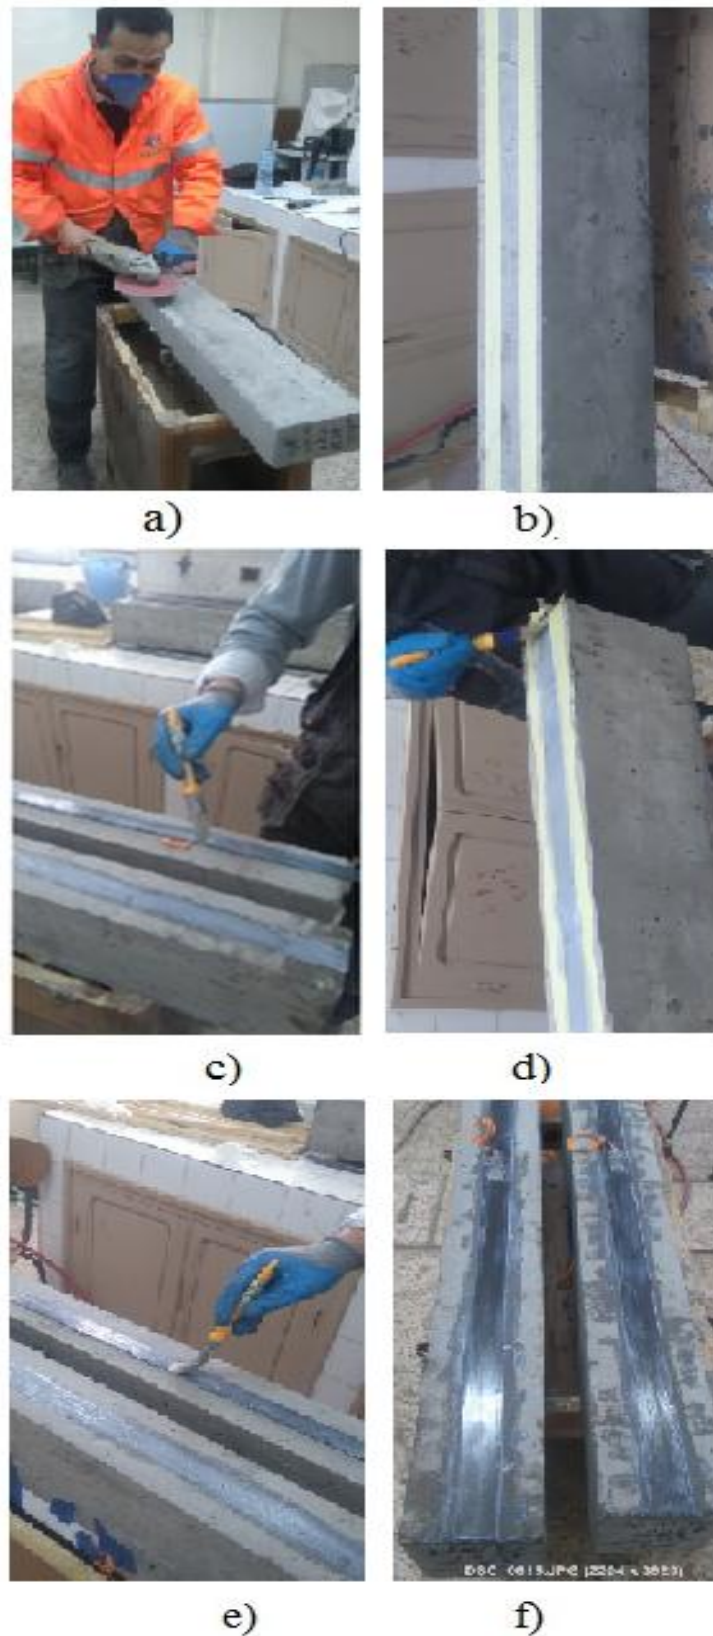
7. Étapes de l'installation du PRFC sur les poutres selon EBR.
